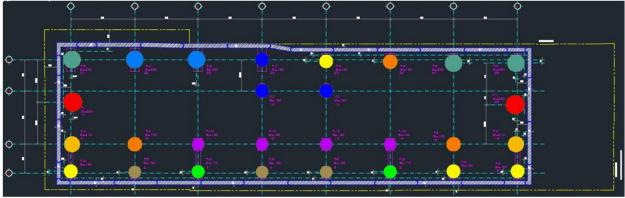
, Sembramdo de Pilas y Muro Milán
